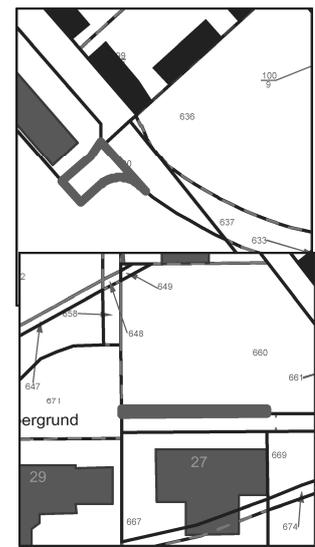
Lageplan zur Spielplatzverlagerung
